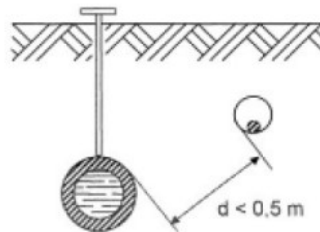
disegno esemplificativo di protezione e segnalazione delle tubazioni
